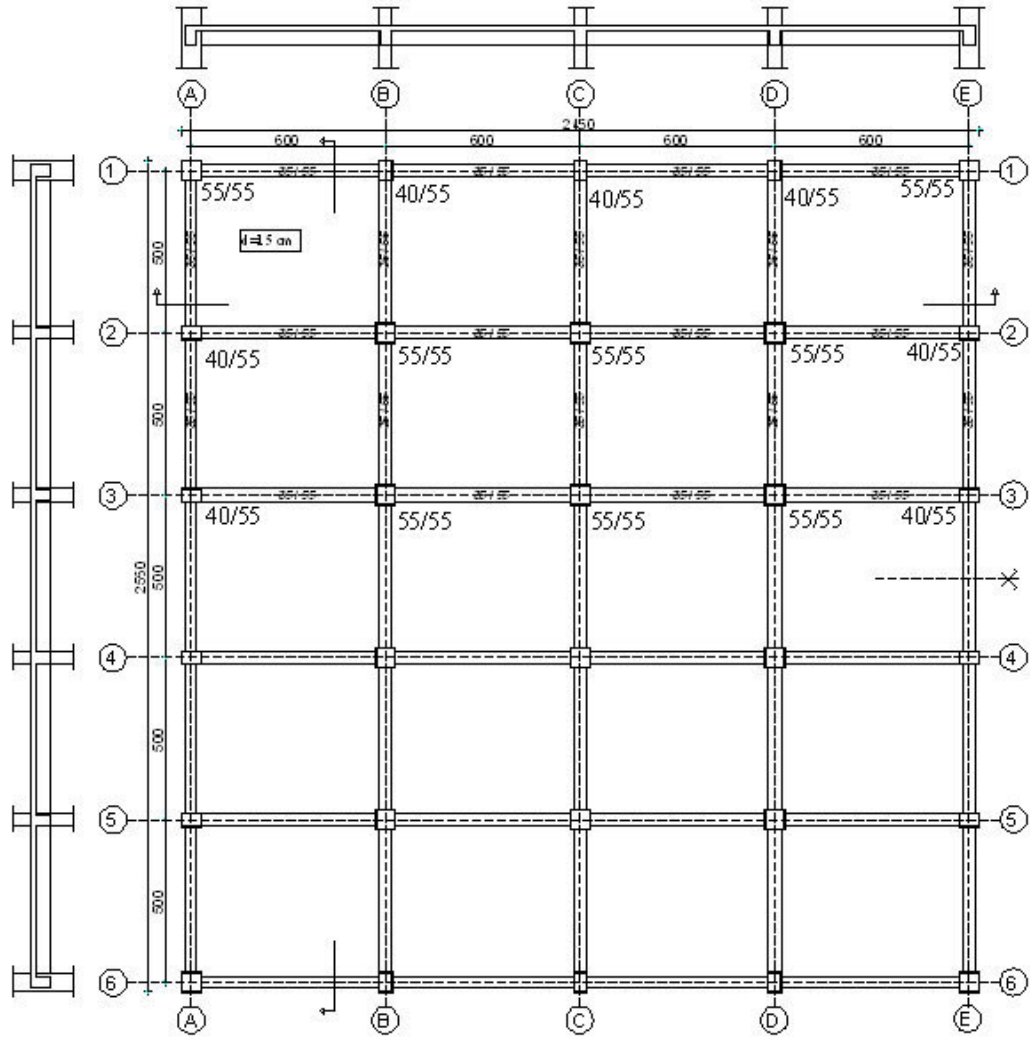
Oluşturulan 11 katlı yapının plan görünüşü.
